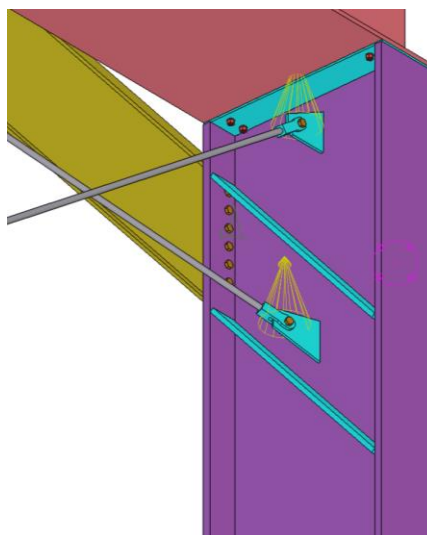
Unió pilar HEB900 - IPE400, pilar HEB900- Biga principal, pilar HEB900 - Cables tirant
